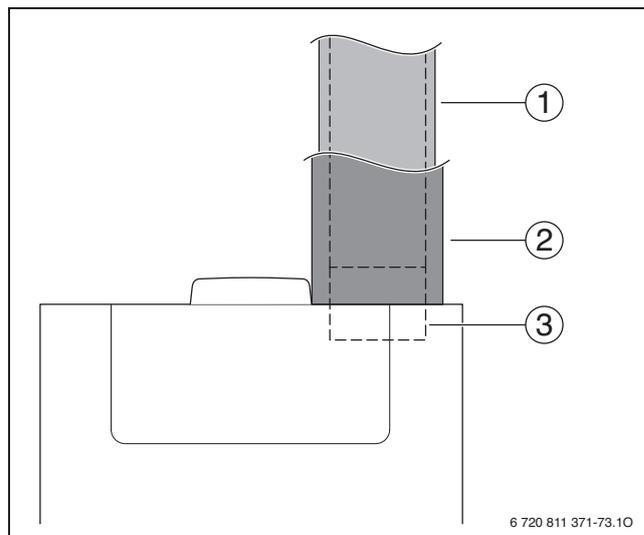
Struttura del collegamento della tubazione dell'aria con tubo in EPP-polipropilene espanso
